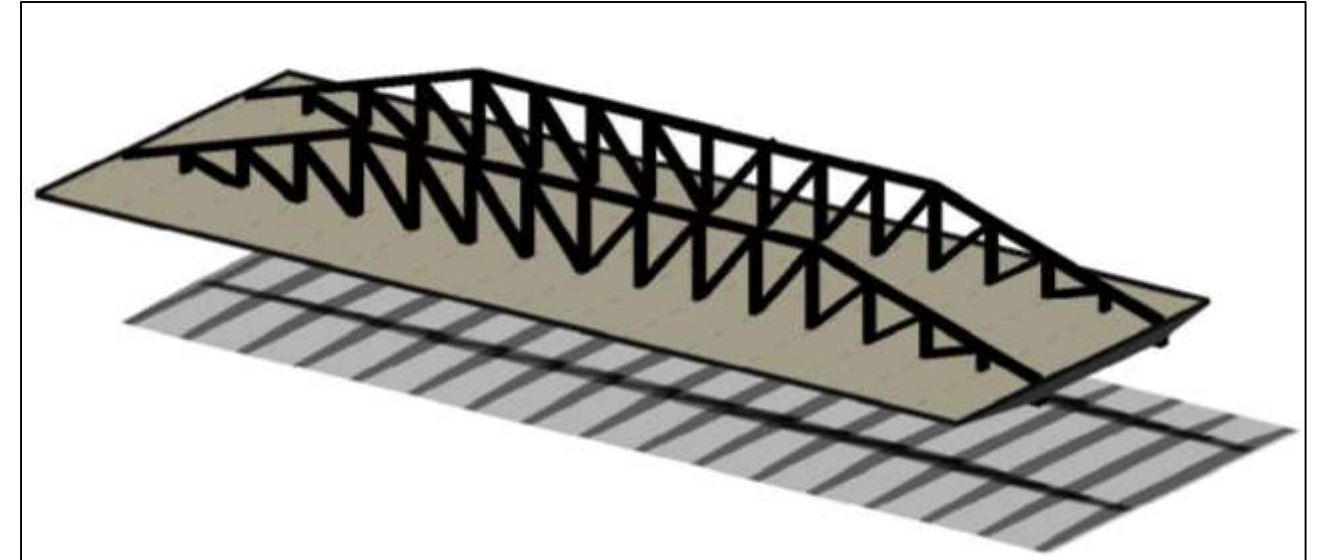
Vista general de la estructura metálica. Fuente: Elaboración propia.
